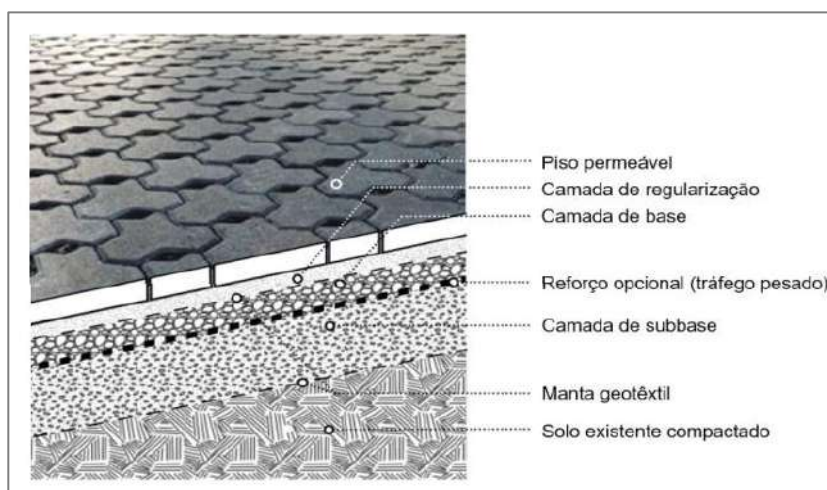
CONFIGURAÇÃO ESQUEMÁTICA DE UM PAVIMENTO PERMEÁVEL.
